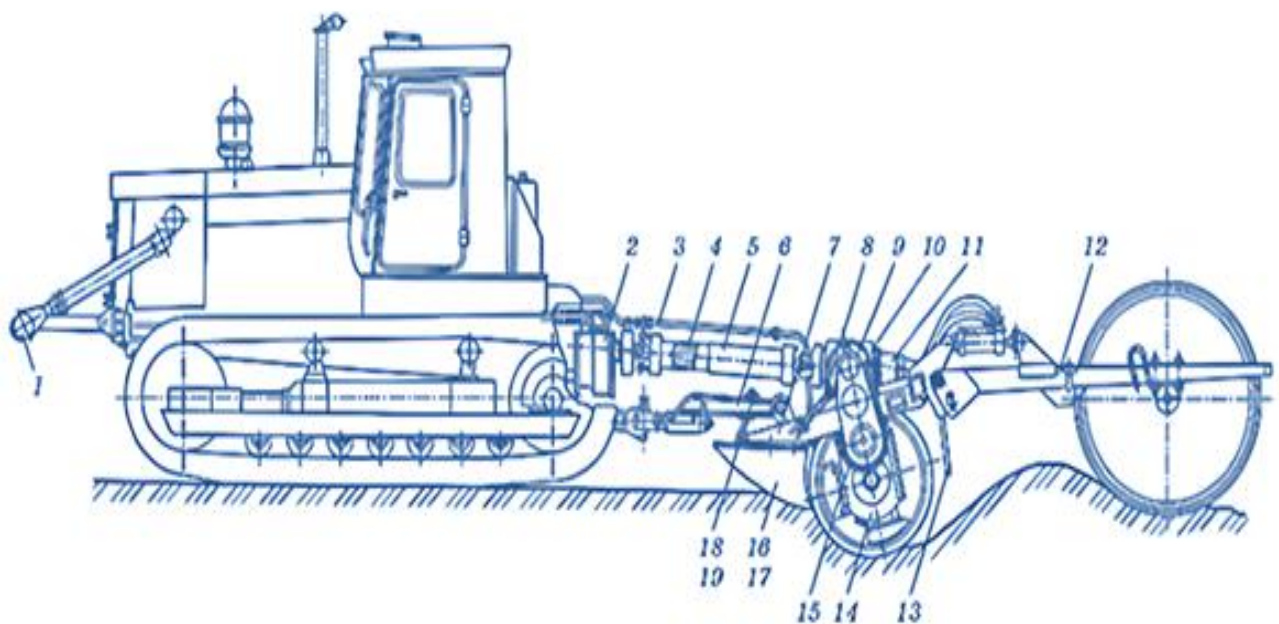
Конструктивна схема фрезерної машини МТП-44А: 1 – передня начіпна система; 2 – ходозменшувач; 3 – гідросистема; 4 – карданна передача; 5 – захисний кожух; 6 – дишло; 7 – рама; 8 – демпфер; 9 – бортовий редуктор; 10 – конічний редуктор; 11 – запобіжна муфта; 12 – задня опора; 13 – сепарувальна гребінка; 14 – фреза; 15 – захисний пристрій; 16, 17 – плити; 18, 19 – тяги
